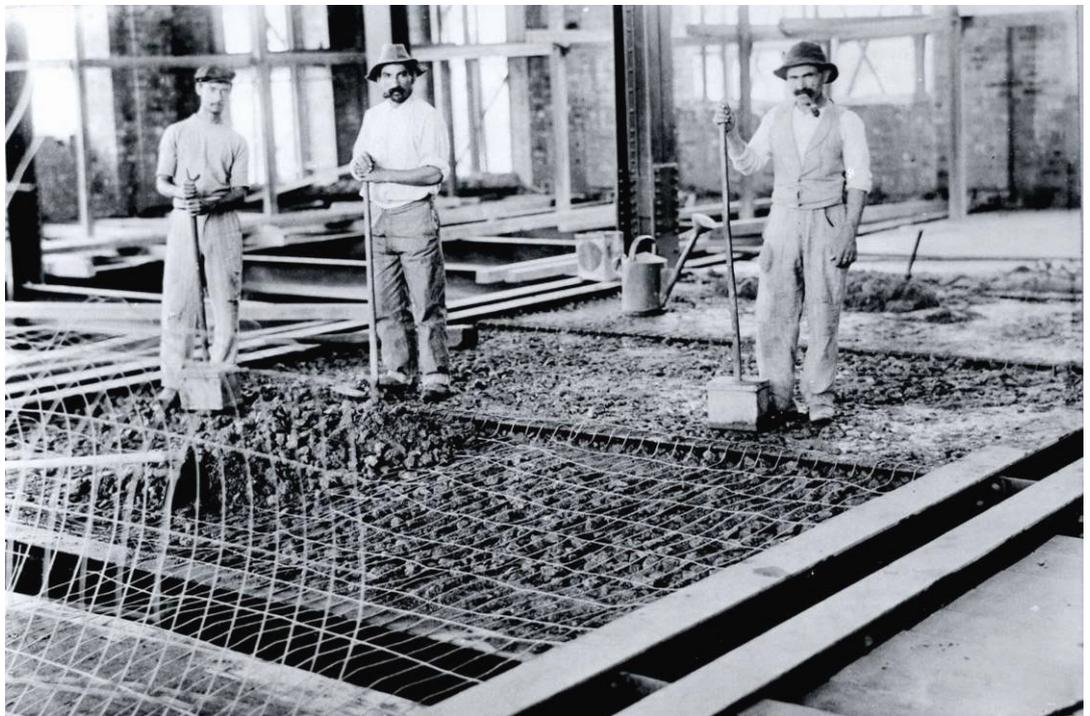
Fotografia da execução do piso de um pavimento em concreto de cimento armado. Podem ser observados os materiais e equipamentos utilizados nos serviços: adensador manual (pilão), concreto já lançado entre as vigas metálicas e a malha metálica posicionada na camada superior do piso. (Álbum da Construção, sem data, cerca de 1906/1907. Seção de Iconografia – FBN).
